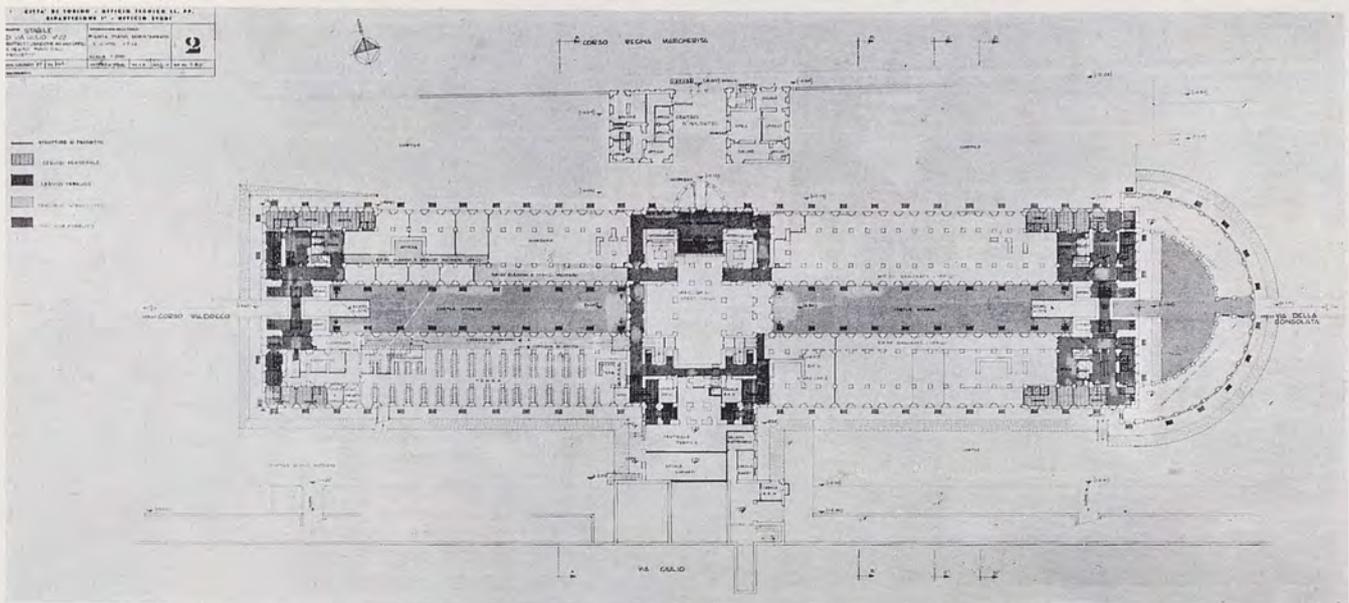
a - Il progetto di ristrutturazione: pianta del seminterrato.
